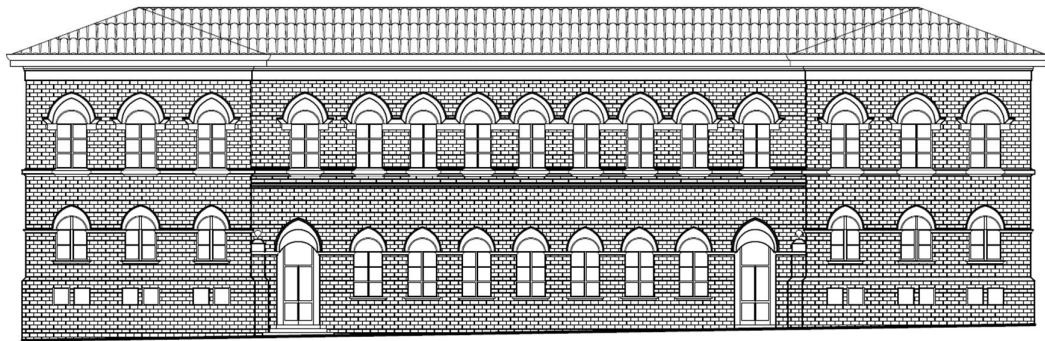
Prospetto A (precedentemente definito Nord o di valle)
